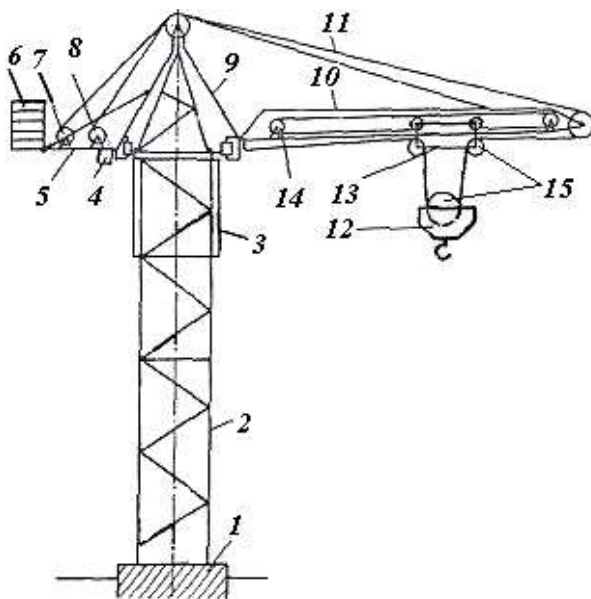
Схема баштового крана з неповоротною баштою:
